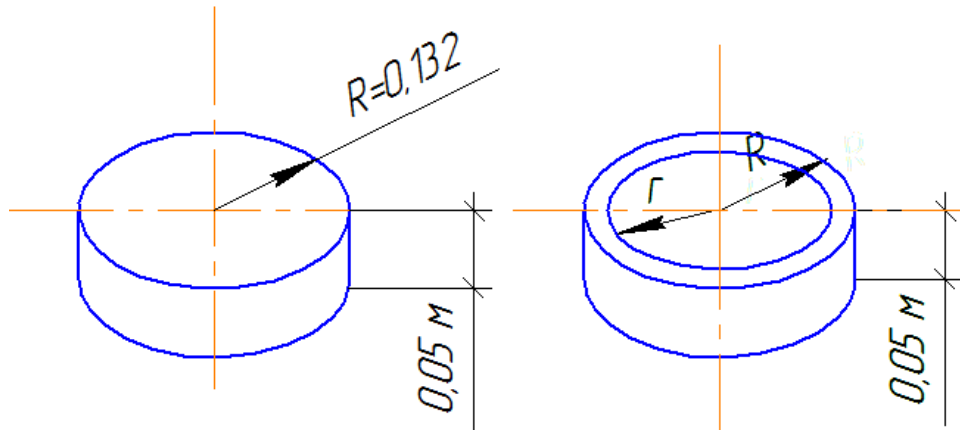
Схеми досліджуваних моделей фундаменту
